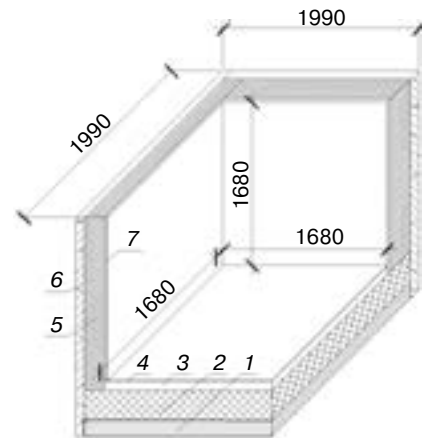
Пространственный фрагмент ограждения: 1 – монолитное железобетонное перекрытие; 2 – утеплитель из пенополистирола; 3 – цементно-песчаная стяжка; 4 – линолеум; 5 – утеплитель стены из пенополистирола; 6 – железобетонная панель; 7 – штукатурка из цементно-песчаного раствора по сетке, натянутой на коннекторах
